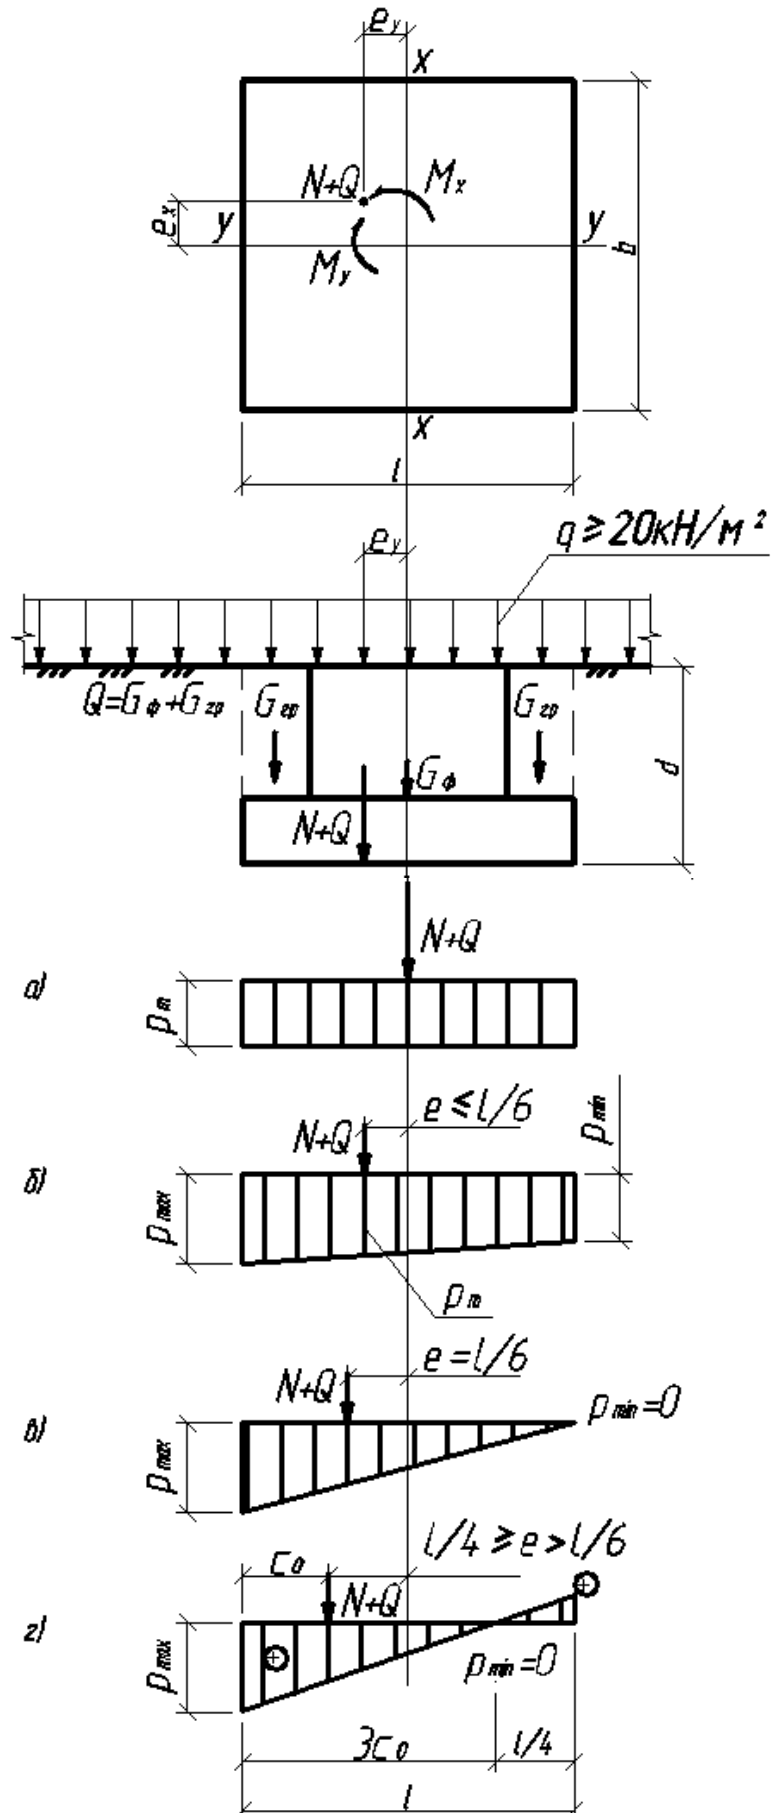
Схема действия сил на фундамент и эпюры контактных давлений на грунт в уровне подошвы фундамента при центральной и внецентренной нагрузках
